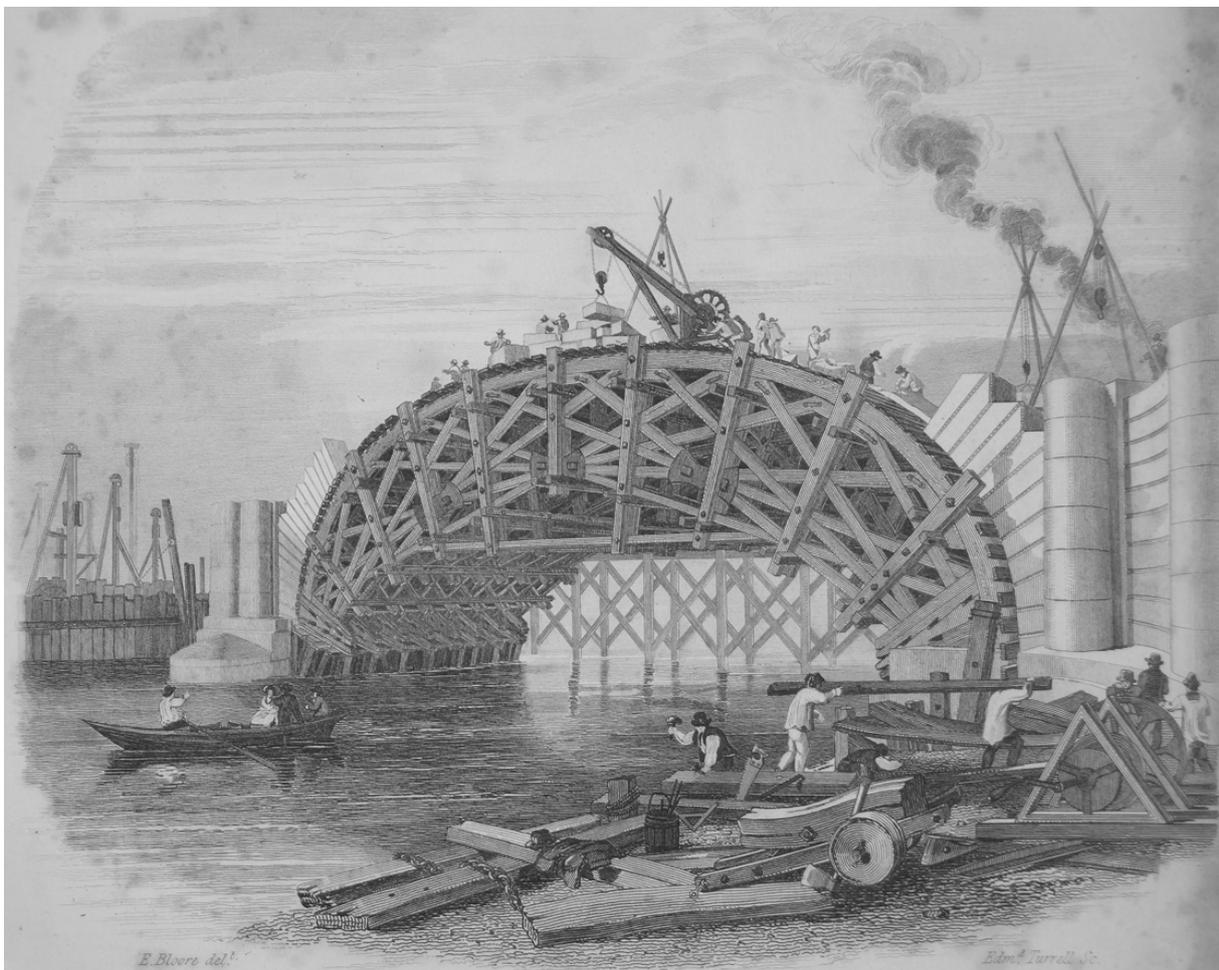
Ansicht der Waterloo-Bridge, London, mit Lehrgerüst<sup>13</sup>.
